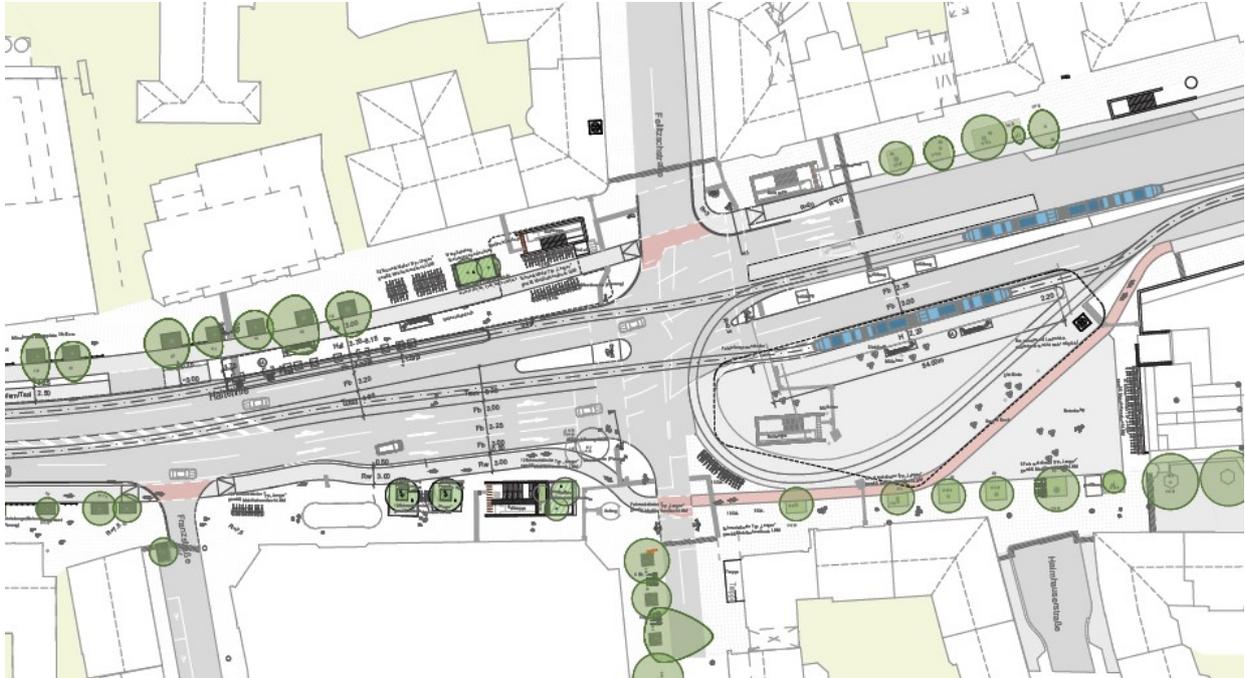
Lageplan V4 (Quelle: SWM/MVG, mgk Landschaftsarchitekten)
